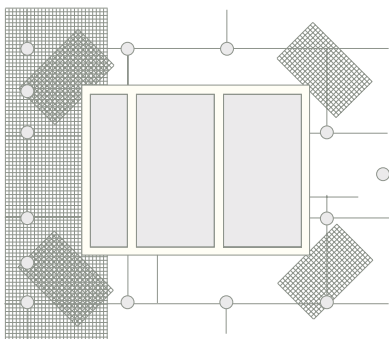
Раскладка утеплителя с перевязкой швов, устройство технологических вырезов в плитах утеплителя около проемов, установка дополнительных косынок из стеклосетки.
